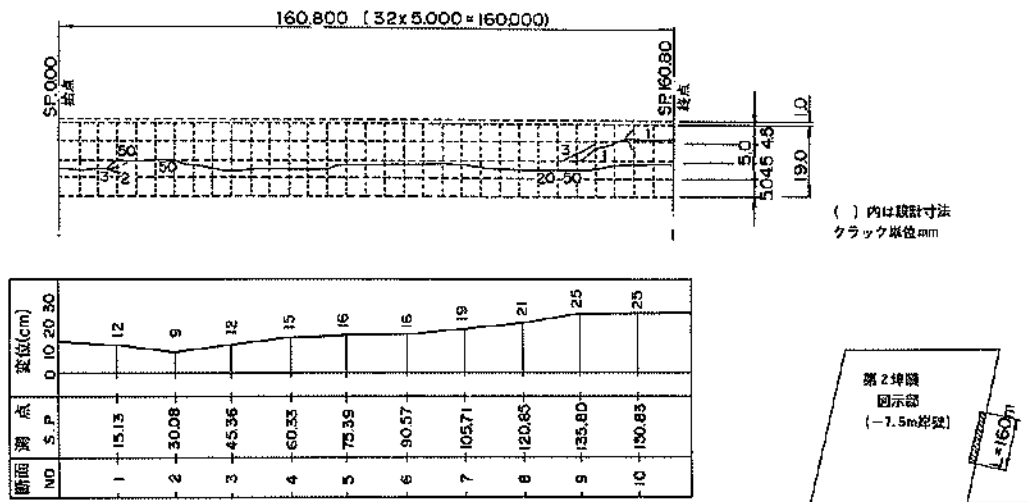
被災状況平面図・法線変位図 (第2埠頭地区, ⑦西側岸壁(-7.5m))
